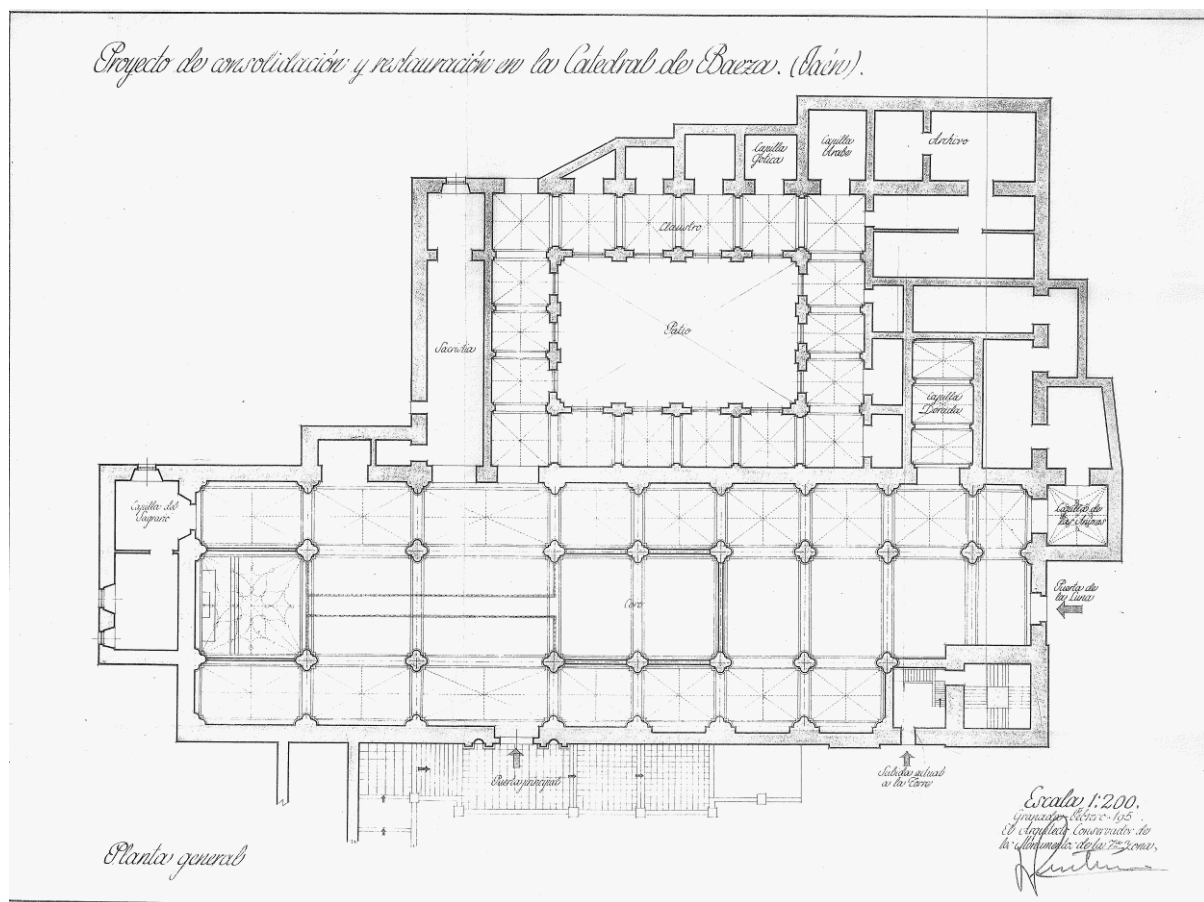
Obras de consolidación y restauración de la Catedral de Baeza AGA, IDD (3)115 caja 26/0280.
